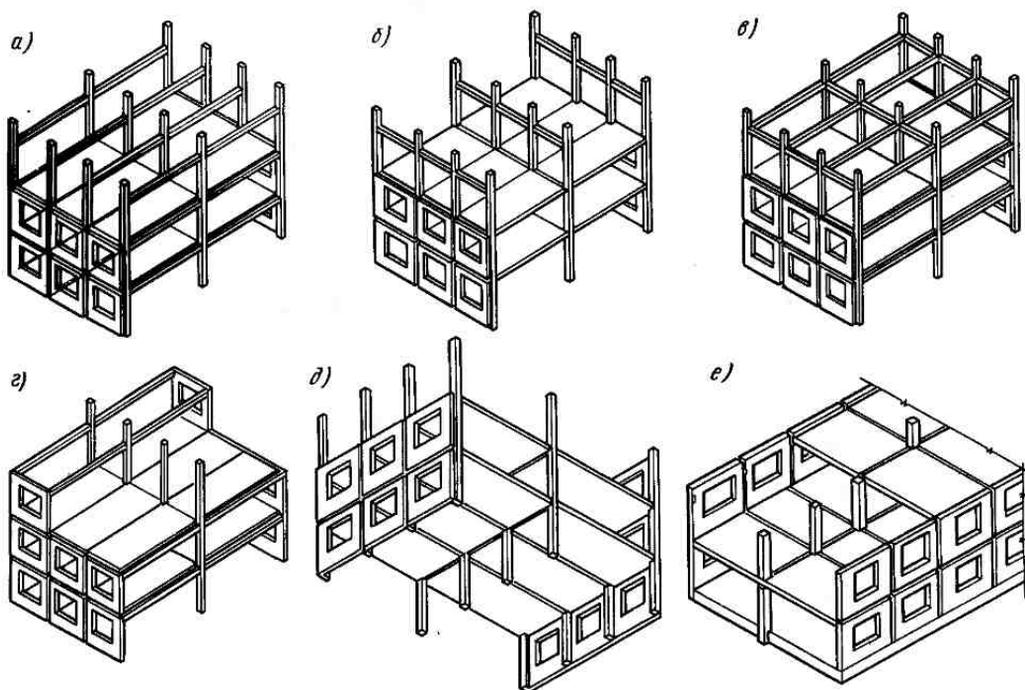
Конструктивные схемы каркасно-панельных зданий
